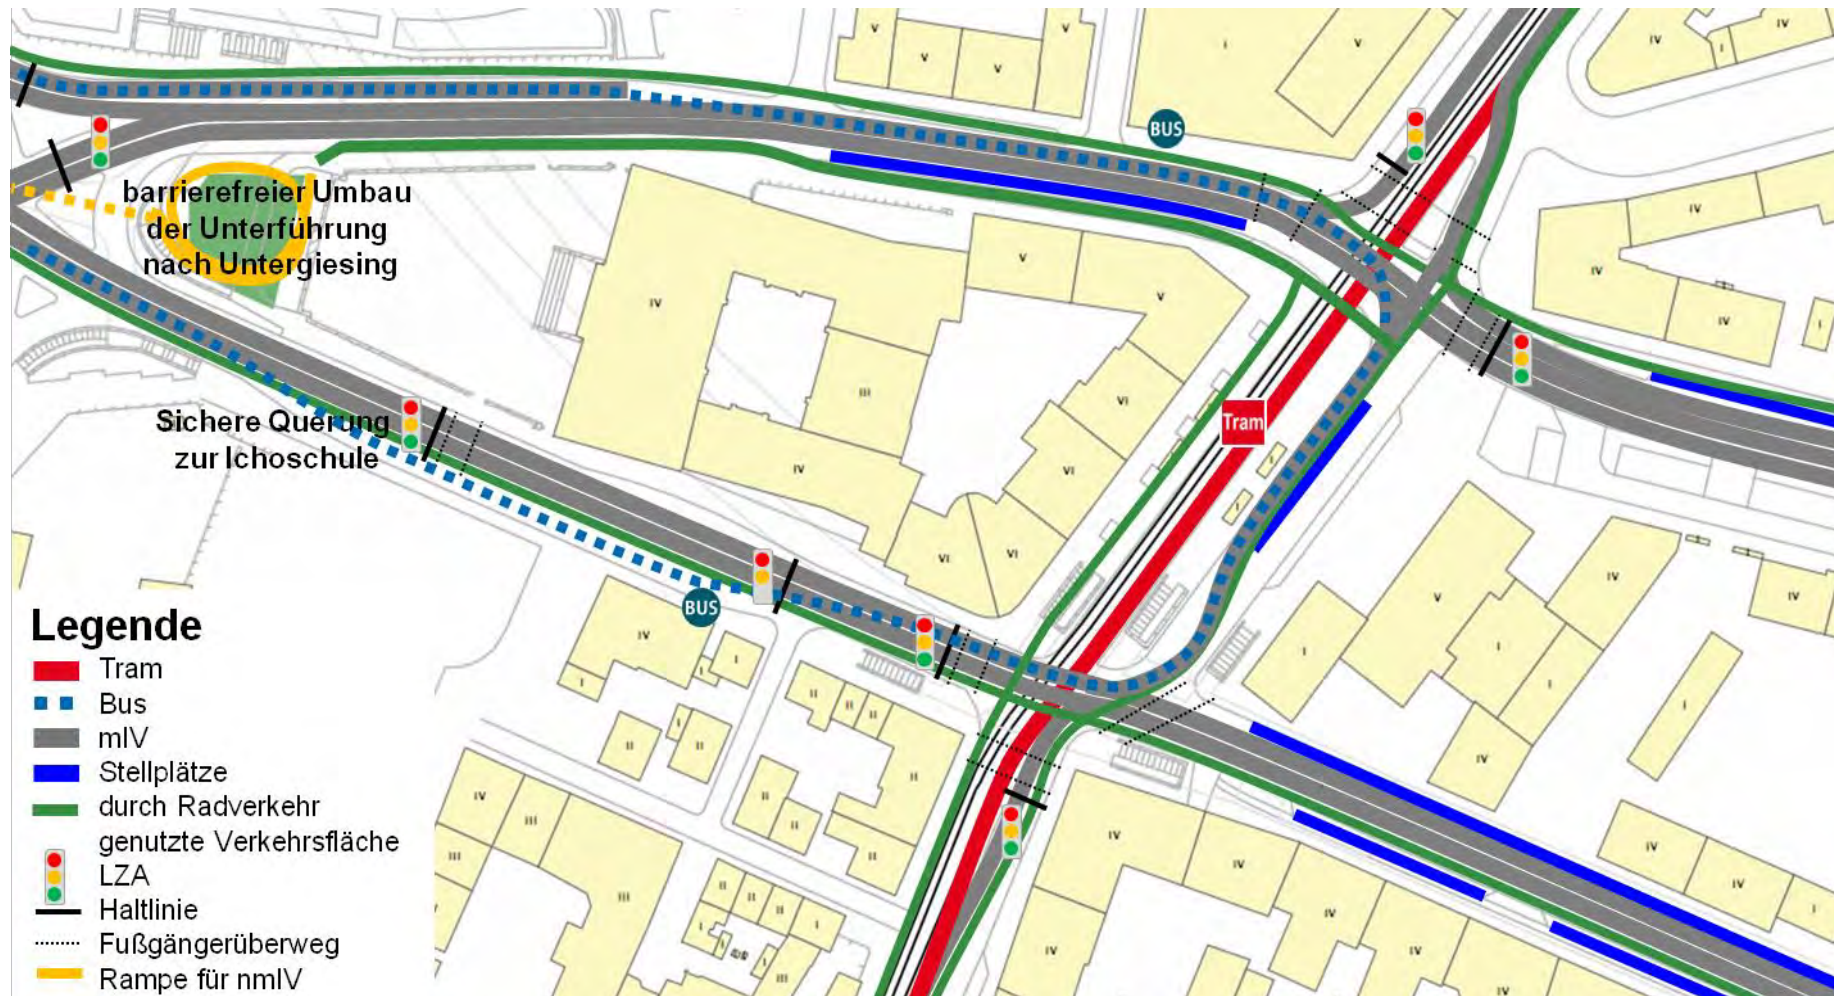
Lageplan des Einbahnstraßensystems (Variante 2)
